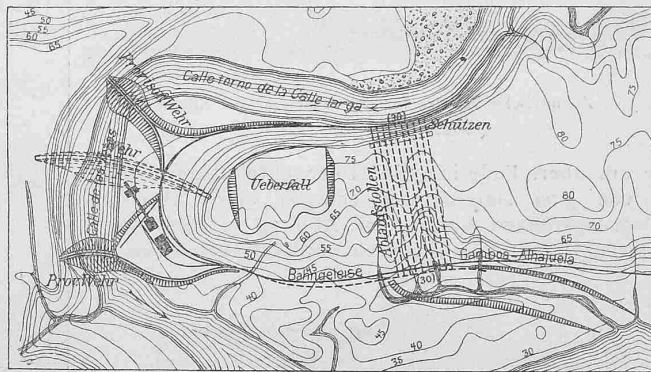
Projektierter Staudamm von Alhajuela. — Lageplan 1:10000.
